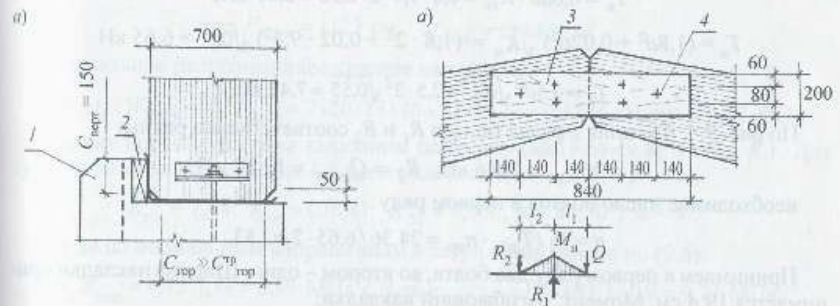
Шарнирные узлы гнuto-клеёной рамы: а – опорный; б – коньковый с расчетной схемой для определения усилий в накладках 3 и болтах 4; 1 – фундамент с армированным выступом; 2 – выравнивающая антисептированная прокладка
